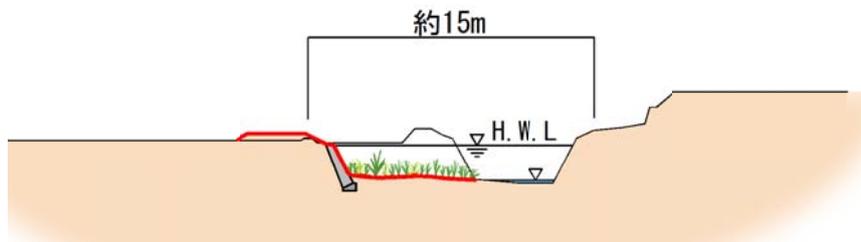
実松川整備計画平面図 (工事施行の場所) 及び代表断面図
